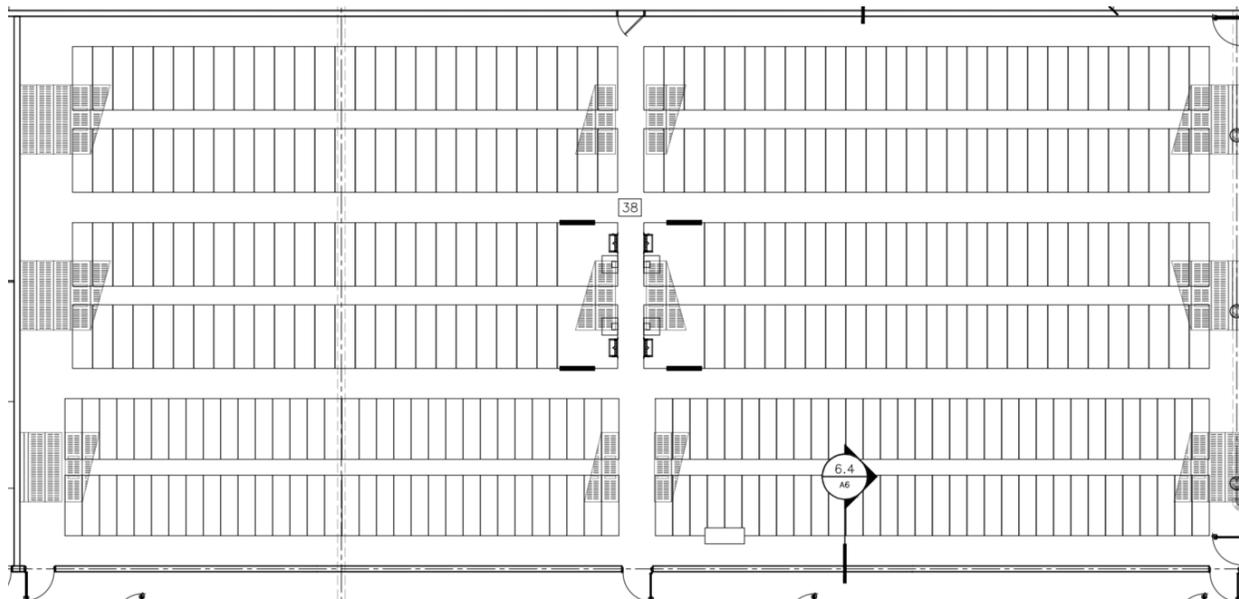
Plan de plancher du bloc saillie (63'-6" x 141'-2")
